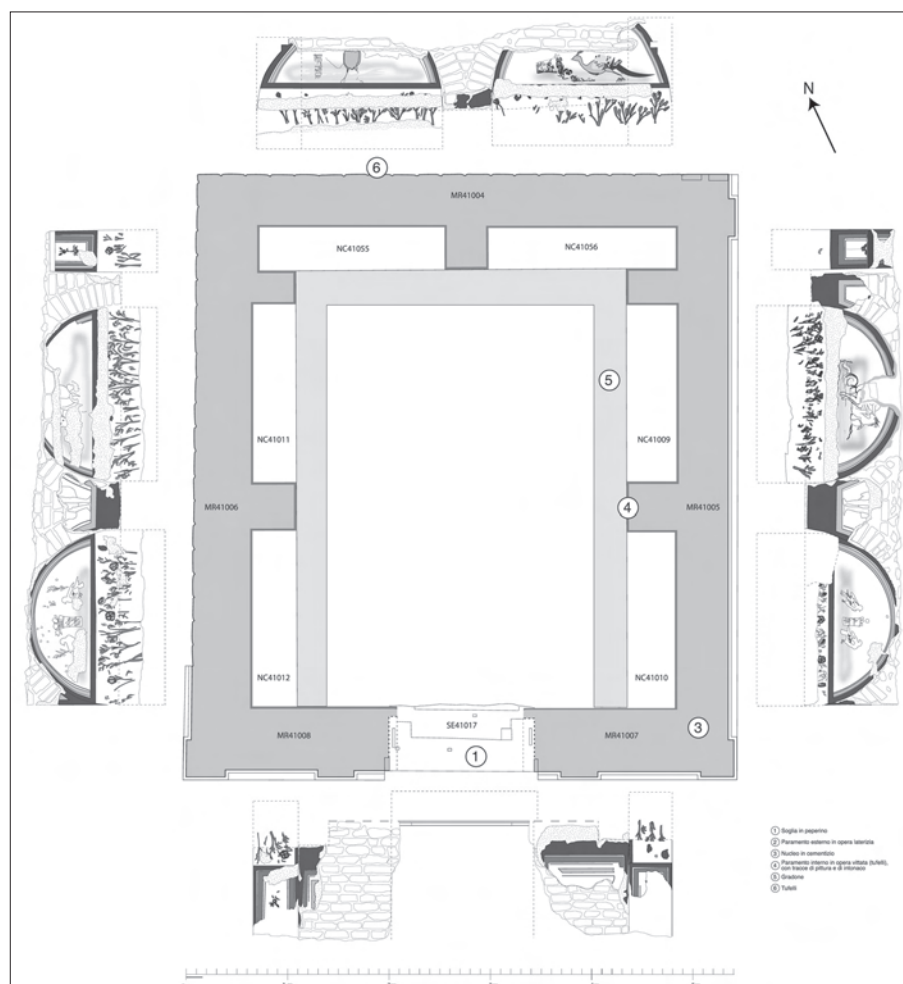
Cuma. Pianta del mausoleo A41 (Elab. grafica M. Pierobon, CJB).
